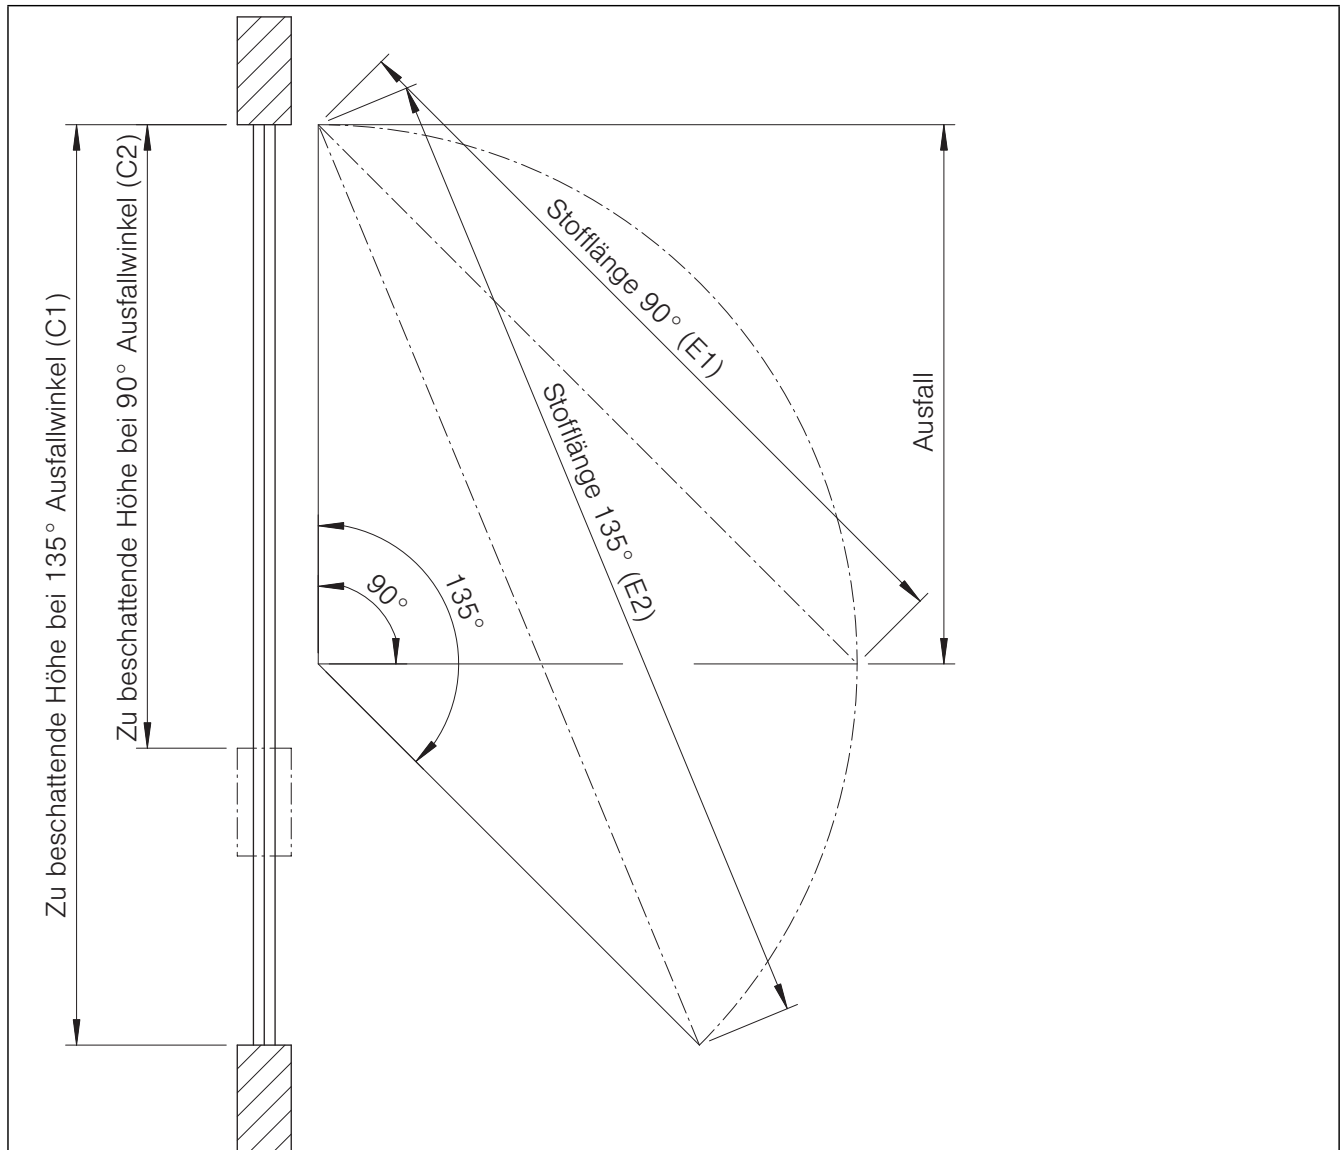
Maßanleitung Fallarm-Markise 330 – Montage in bauseitigen Schacht
